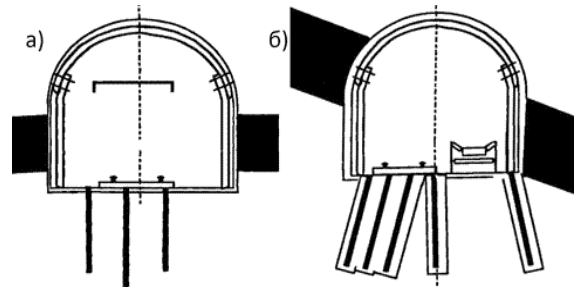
Існуючі схеми розташування анкерного кріплення
